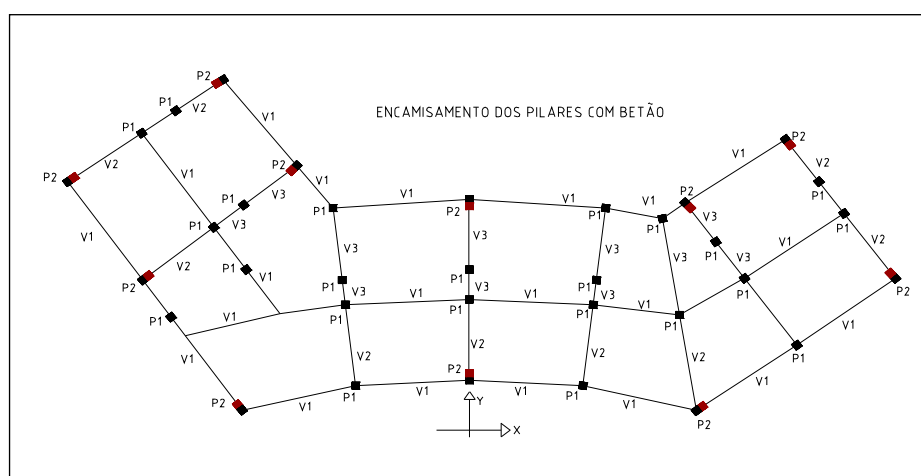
Planta estrutural do edifício reforçado por encamisamento dos pilares existentes.
